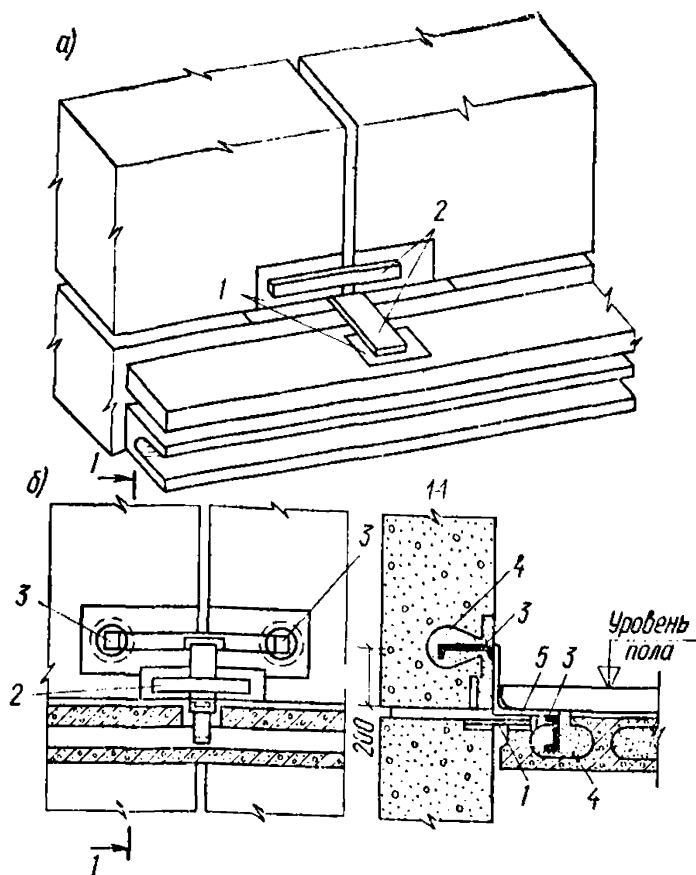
Усиление узла соединения наружных панелей и перекрытия в домах серии 1-468
